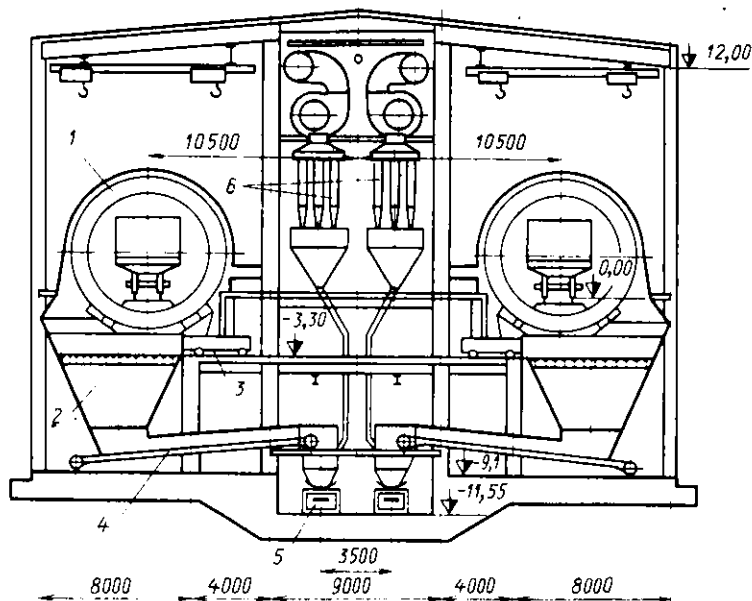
Разгрузочное устройство с двумя роторными вагоноопрокидывателями:
